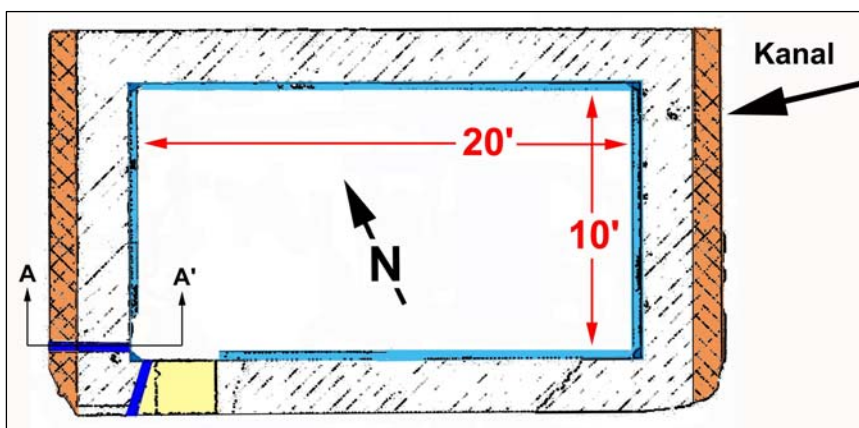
Grundriss, Ausrichtung und Maueraufbau des Beckens (Hellblau: Viertelstab / dunkelblau: Rohbettungen / orange: vorgesetzte Mauerschale aus *opus reticulatum*). Schnitt A – A': siehe Abb. 6.
